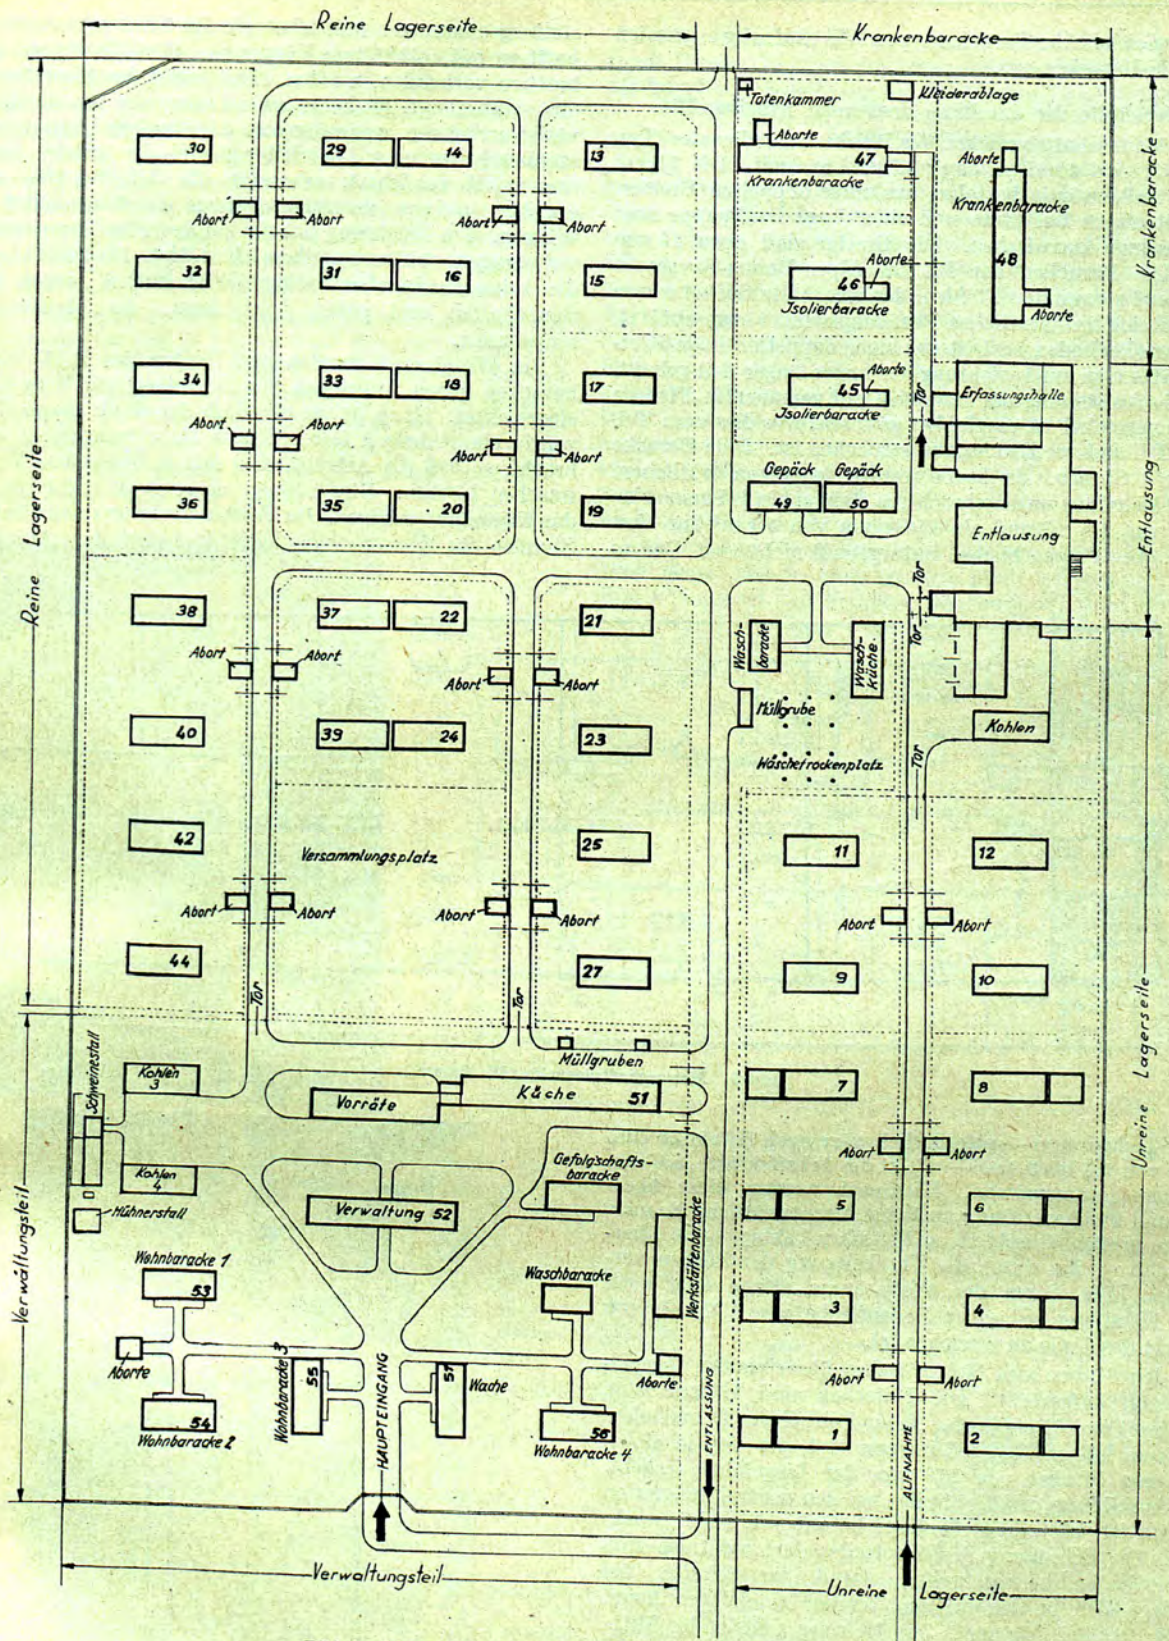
Plan eines großen Durchgangslagers (DL Straßhof).
